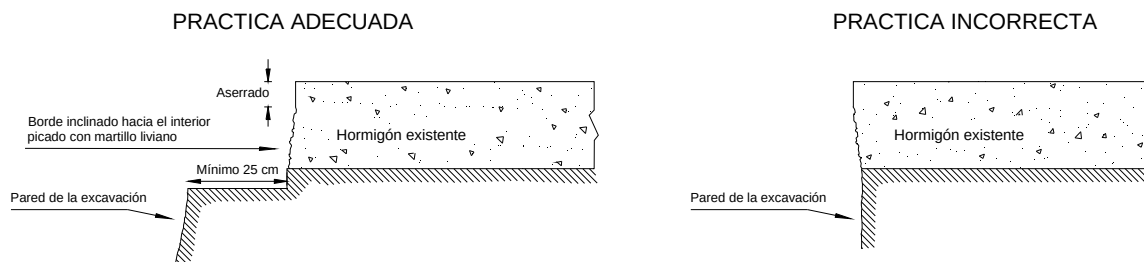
Sección transversal del corte de un pavimento y excavación. Prácticas adecuadas e incorrectas de bacheos en profundidad total o reparación (o nuevo tendido) de servicios públicos, en pavimentos para tránsito liviano.
